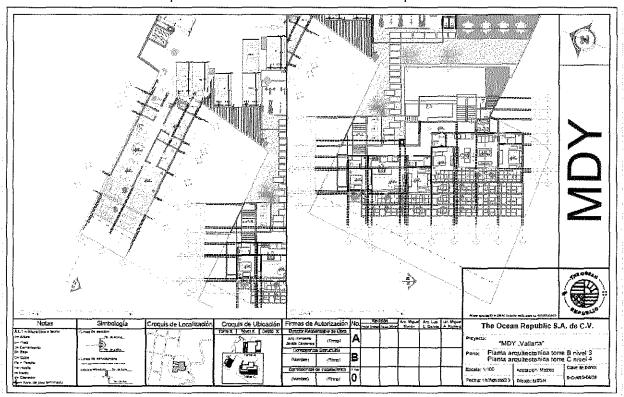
Planta arquitectónica torre B nivel 3. Planta arquitectónica torre C nivel 4
